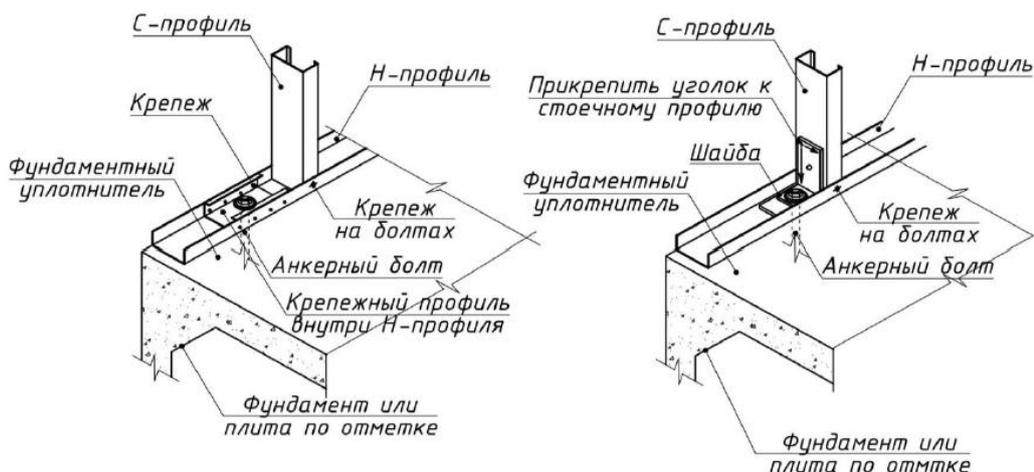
Схема крепление стойки стены к фундаменту
